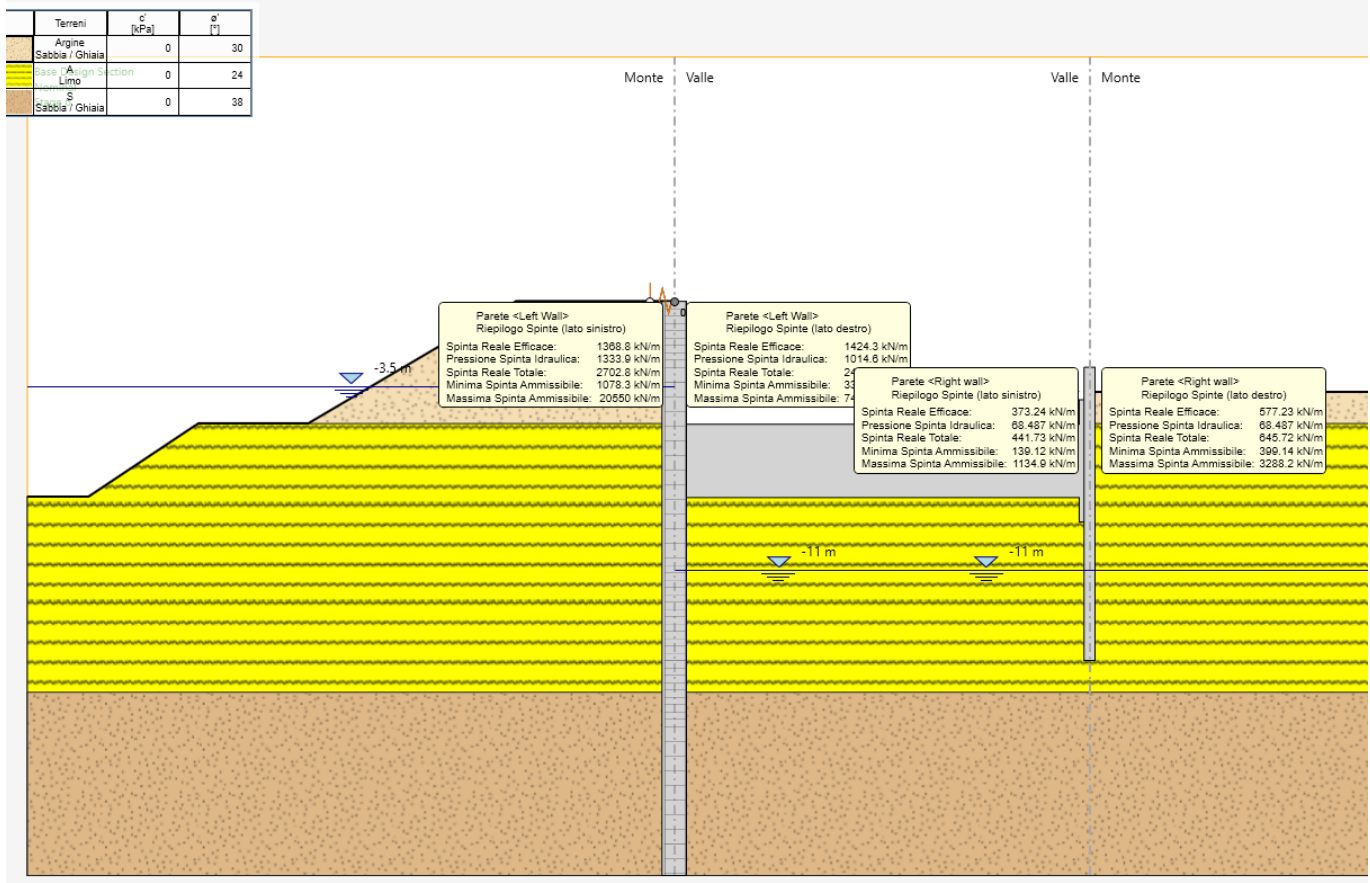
Sezione 2, Riepilogo spinte SLU GEO (A2+M2+R1) – fase 6
